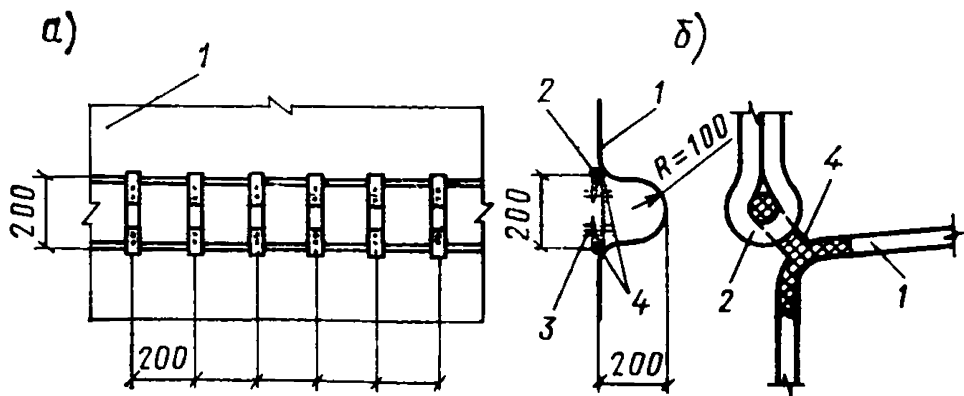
Контурный подпружиненный компенсатор облицовки резервуара
